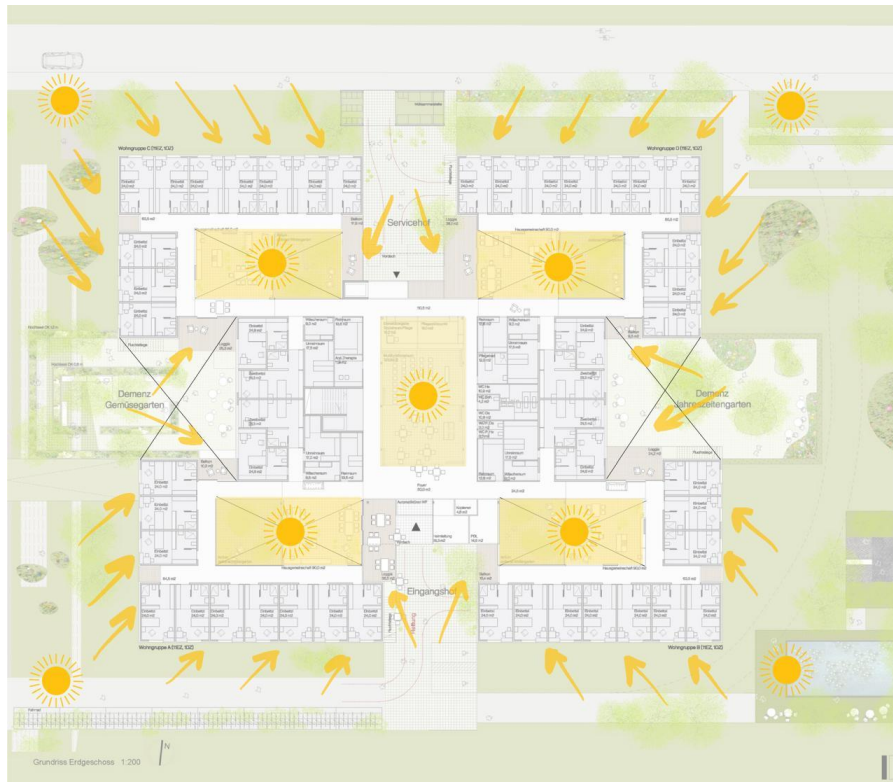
Plano intervenido que muestra las fuentes de iluminación natural. Plano realizado por Dietger Wissounig Architekten e intervenido por autora.
